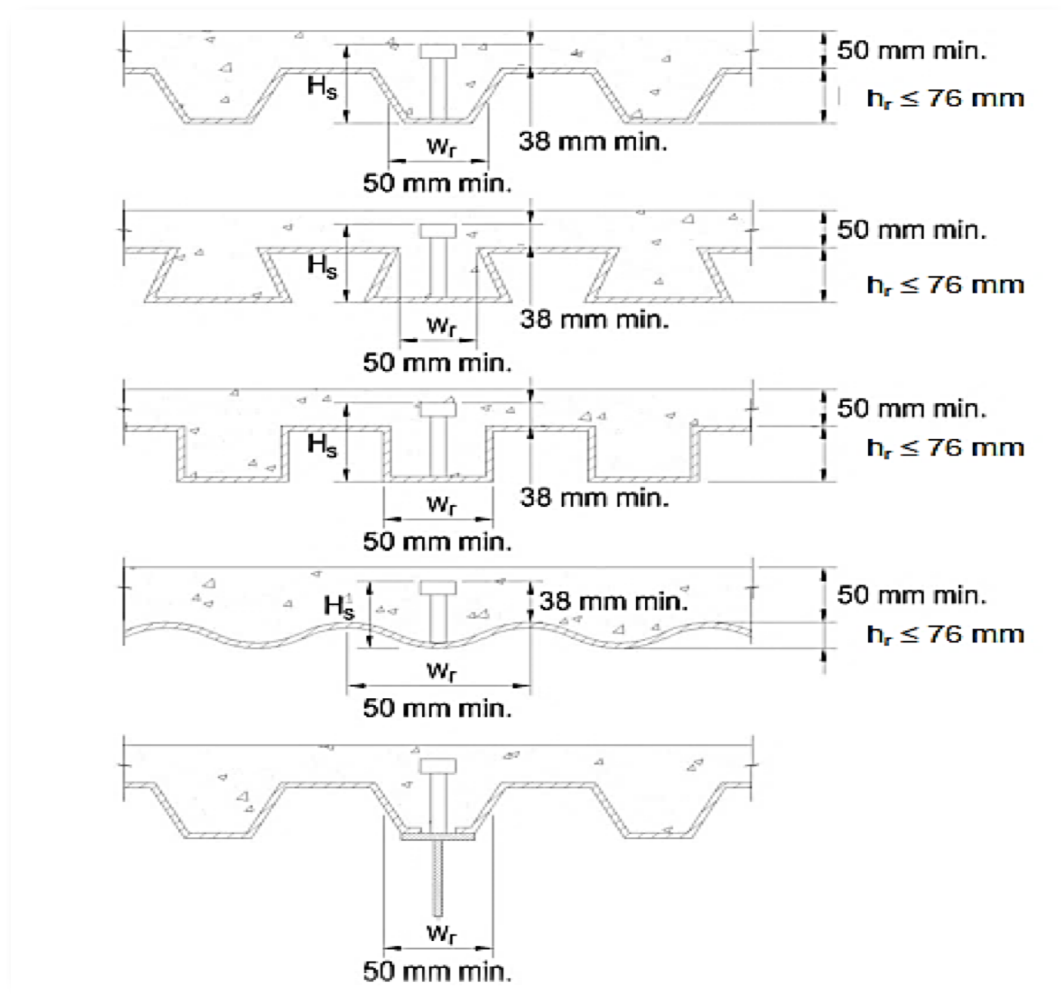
Dimensiones mínimas exigidas para vigas compuestas con losas sobre *Steel deck*. Fuente: AIS (2010)
